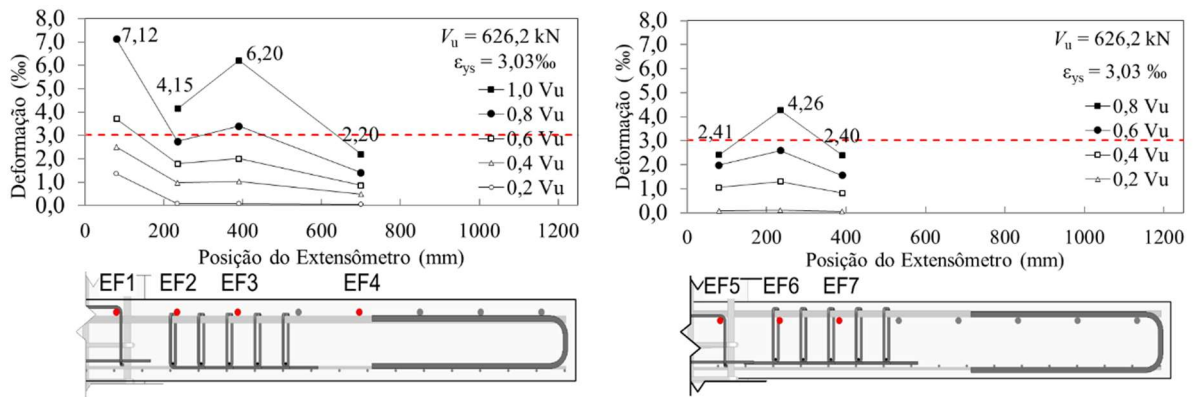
Deformações nas armaduras de flexão da laje CTA
